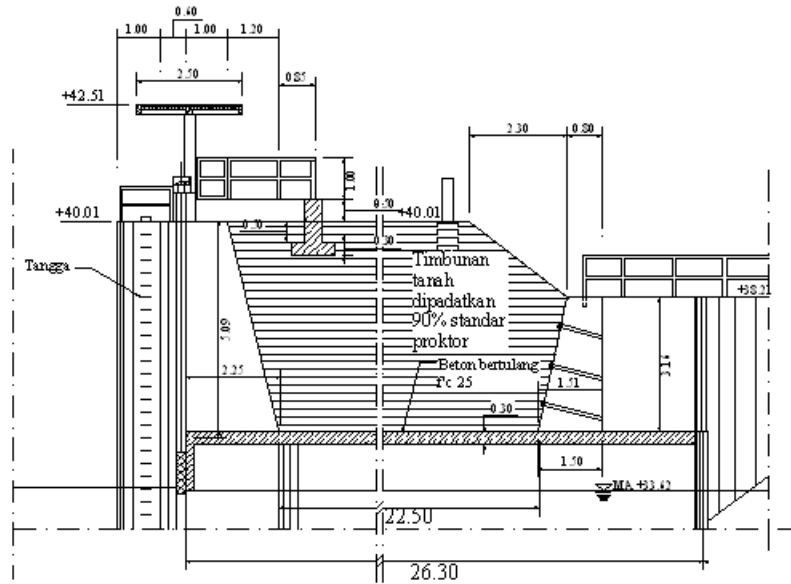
Galian Pondasi pada Bangunan Penguras
